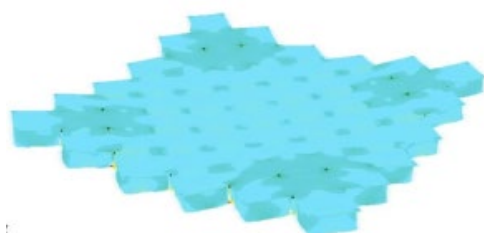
Verbindungsprinzip 3 - im Grundriss
